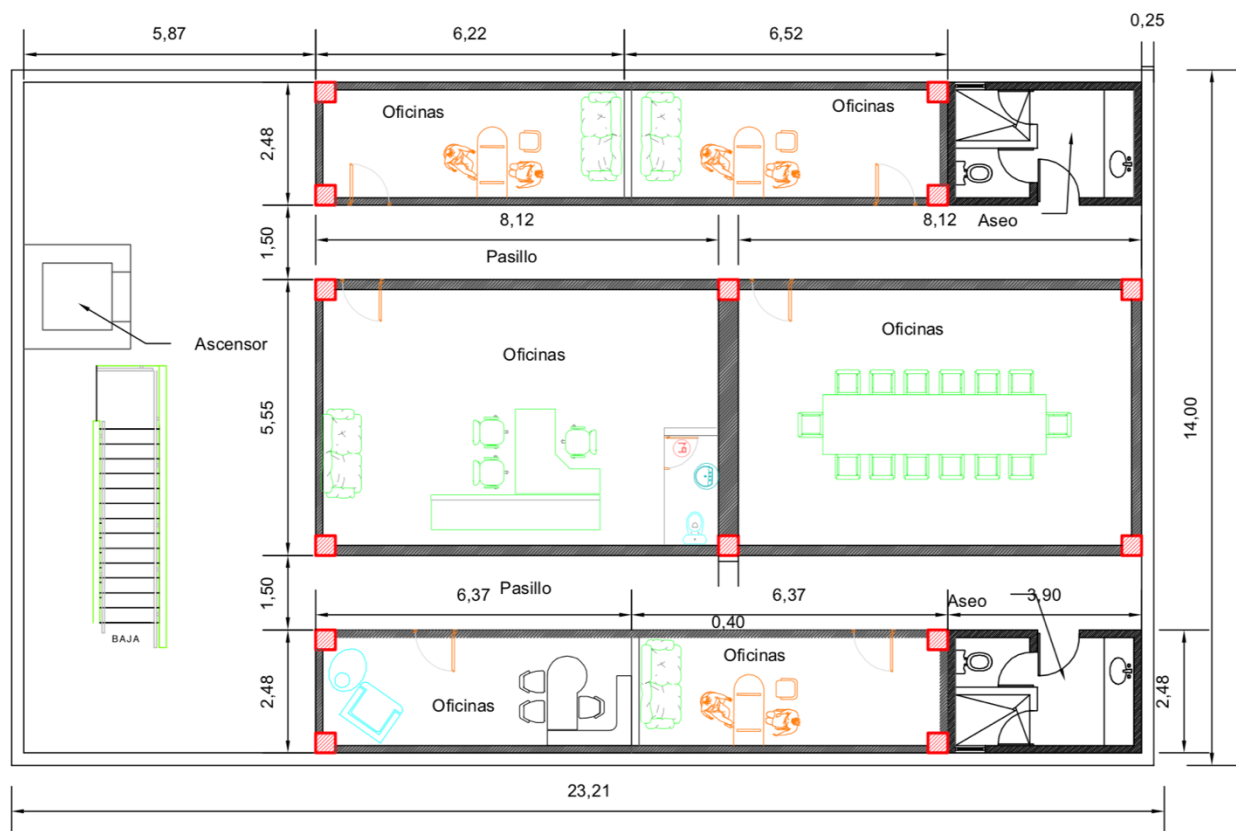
Planta general de la planta de oficinas del edificio de la estación
